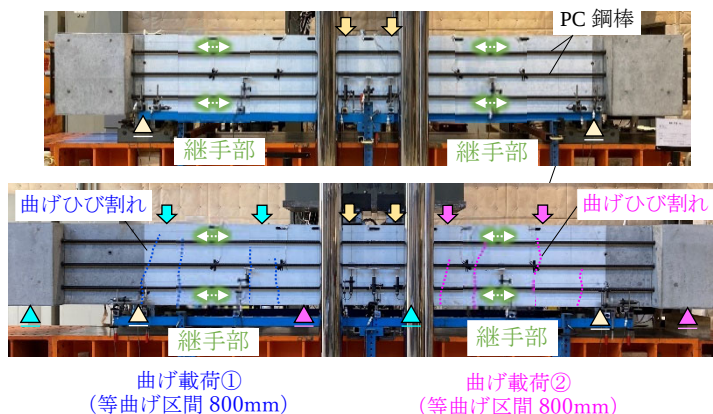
載荷状況（上：No.1 試験体，下：No.2 試験体）
